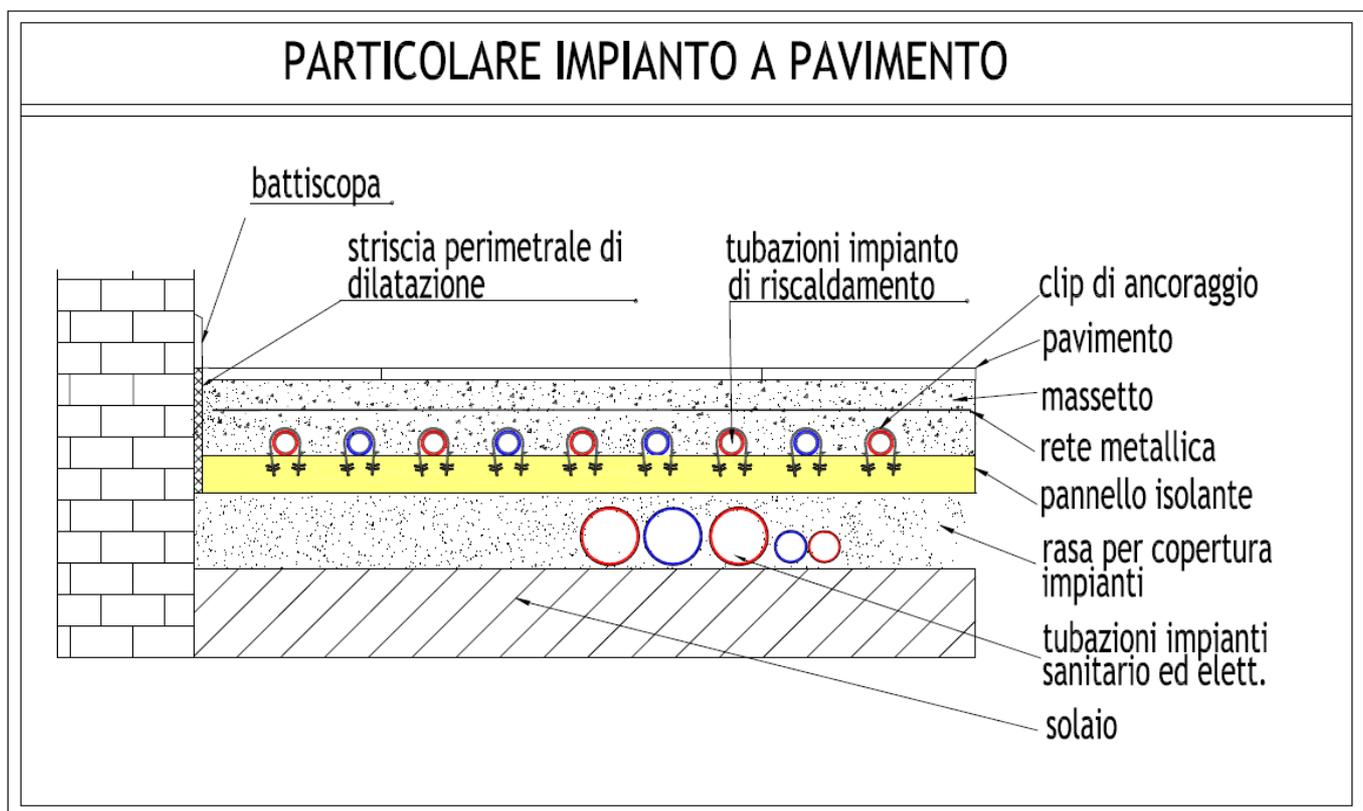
Sezione tipica di un impianto a pavimento radiante
